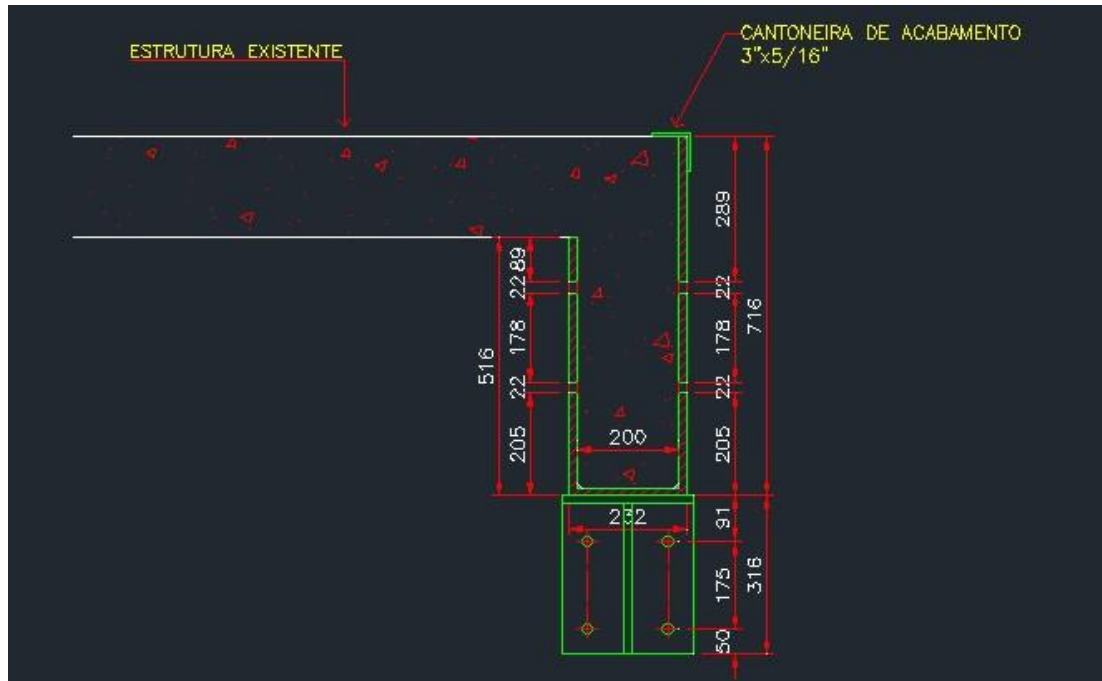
Reforço estrutural com uma viga metálica abaixo da viga de concreto
